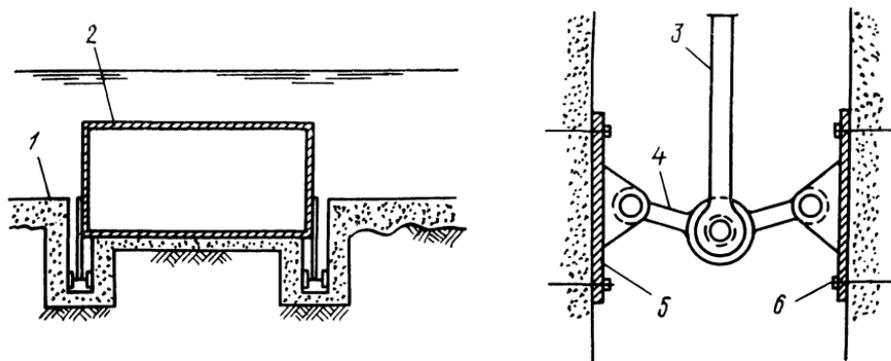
Способ присоединения конструкций к фундаментам.
